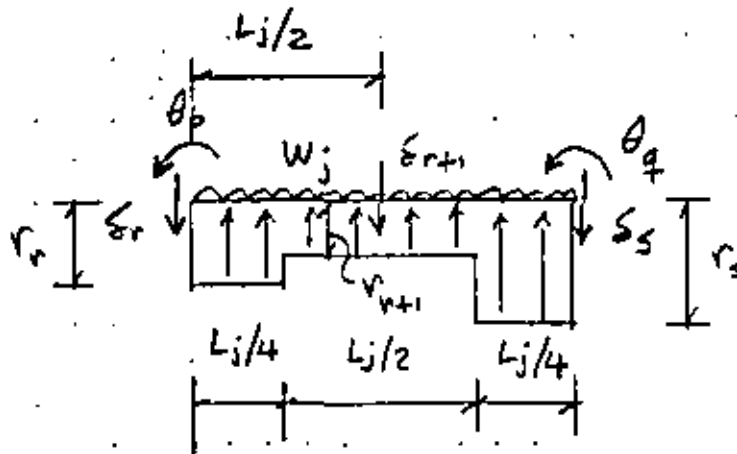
Desplazamiento δ_{r+1} a la mitad del entre-eje j , en la cimentación. Barra con apoyos continuos
